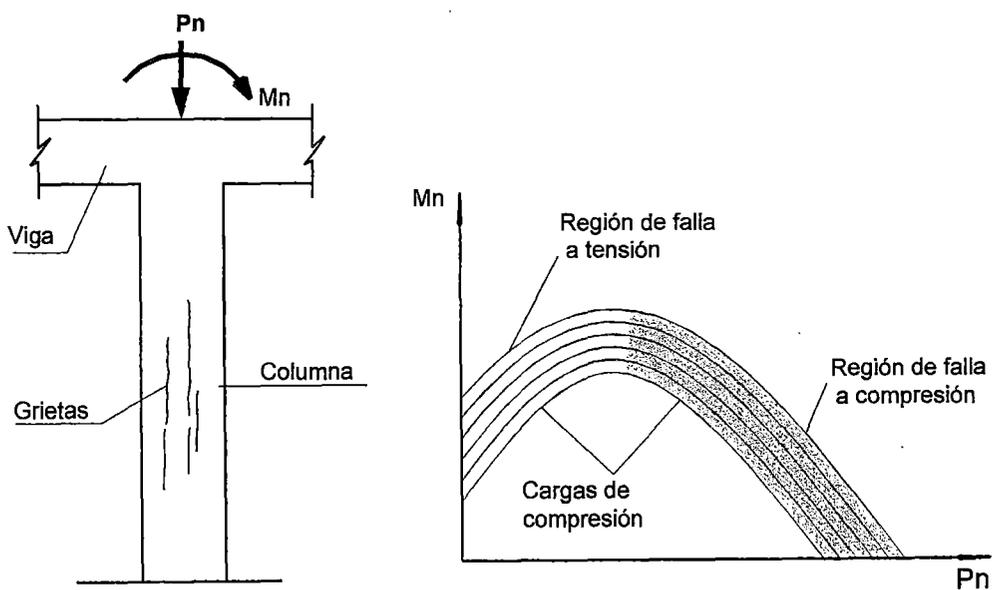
Grietas en columna de concreto armado.
